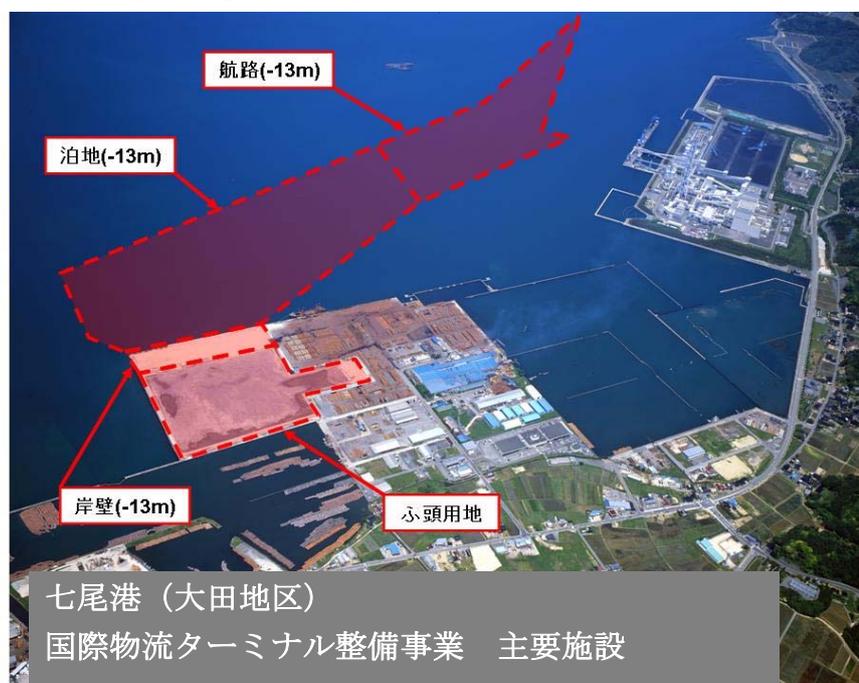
七尾港 国際物流ターミナル整備事業 主要施設平面図
